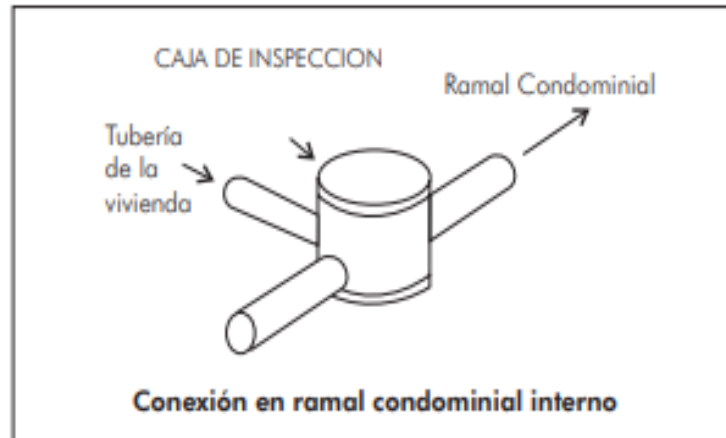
Conexión de un ramal y caja de inspección dentro de un lote
